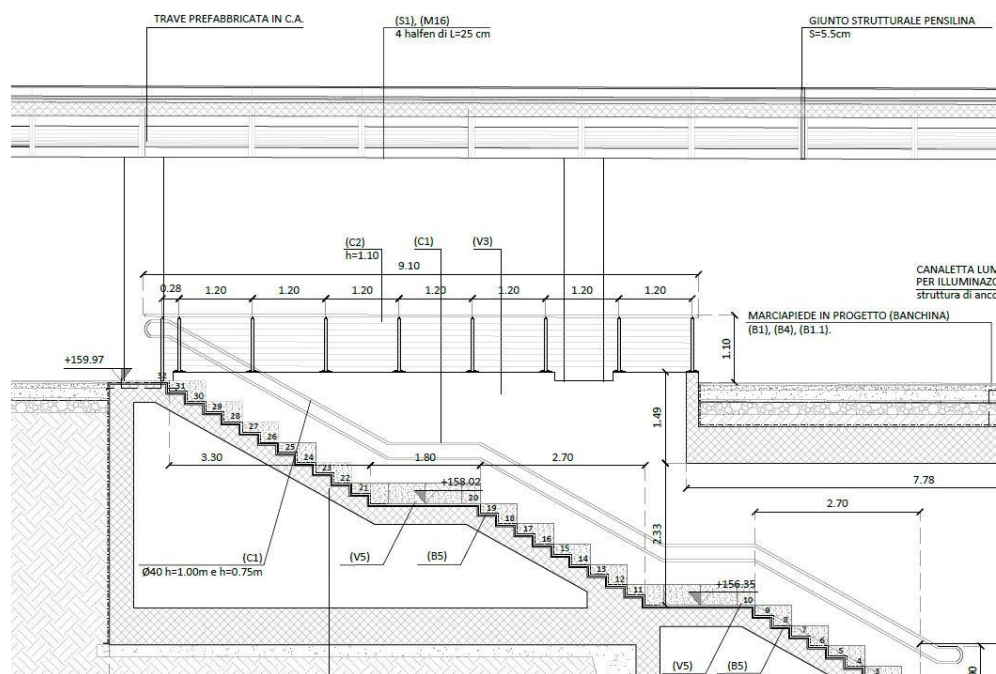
Stralcio sezione longitudinale sulla pensilina ferroviaria
